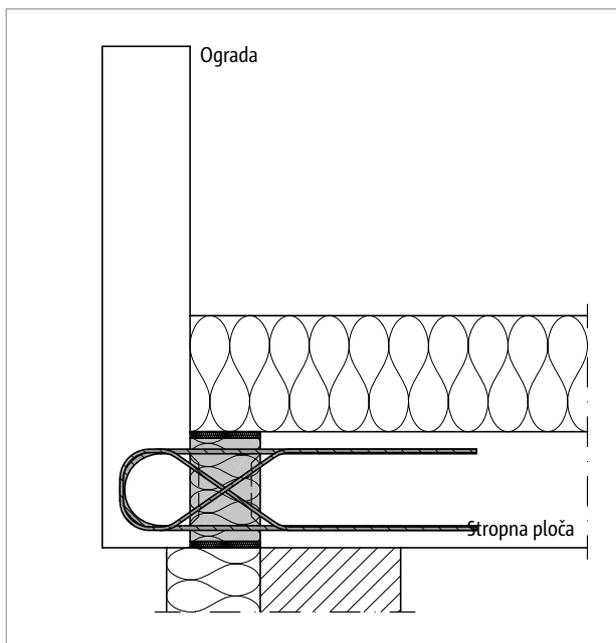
Schöck Isokorb® XT/T tip AP horizontalna ugradnja: Pogled, parapet pored ploče
